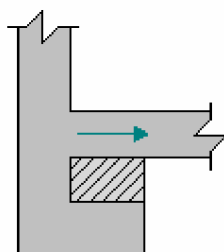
Alternativa de apoyo de la viga de enlace en la zapata medianera.
